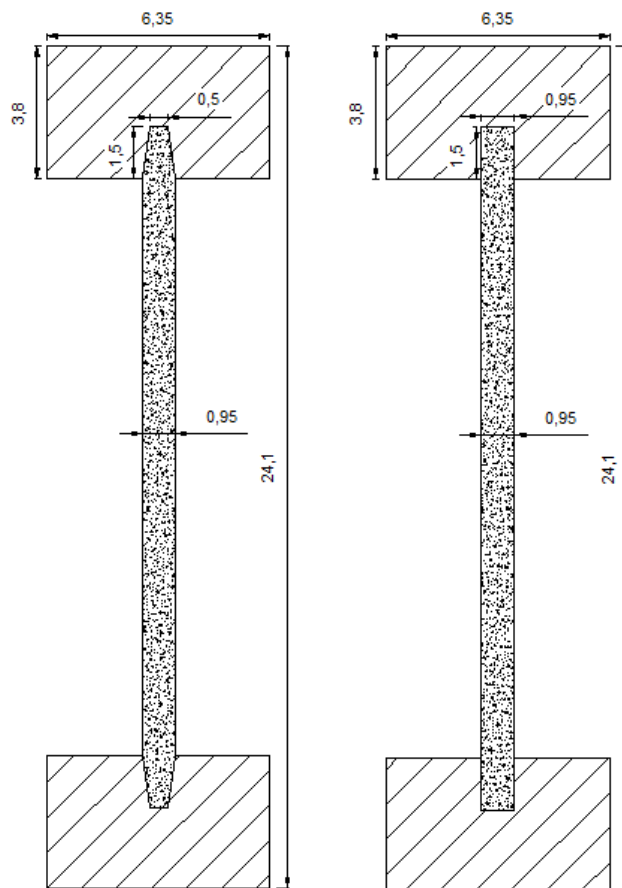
Seção transversal das vigas, detalhe dos encaixes
